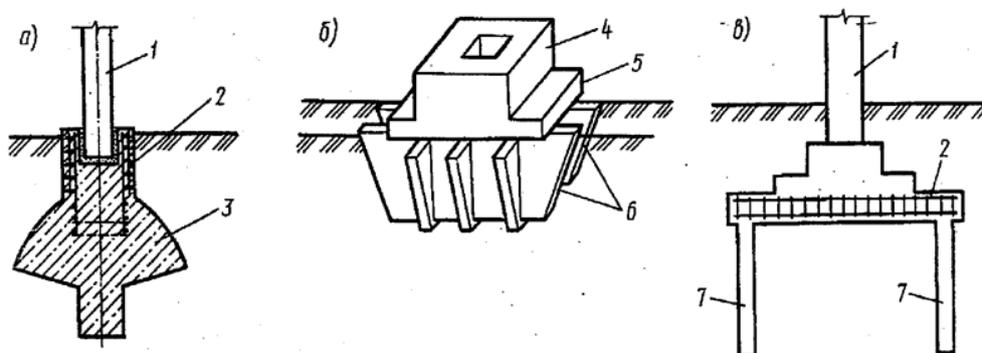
Буробетонные (а), щелевые (б), и анкерные (в) фундаменты:
